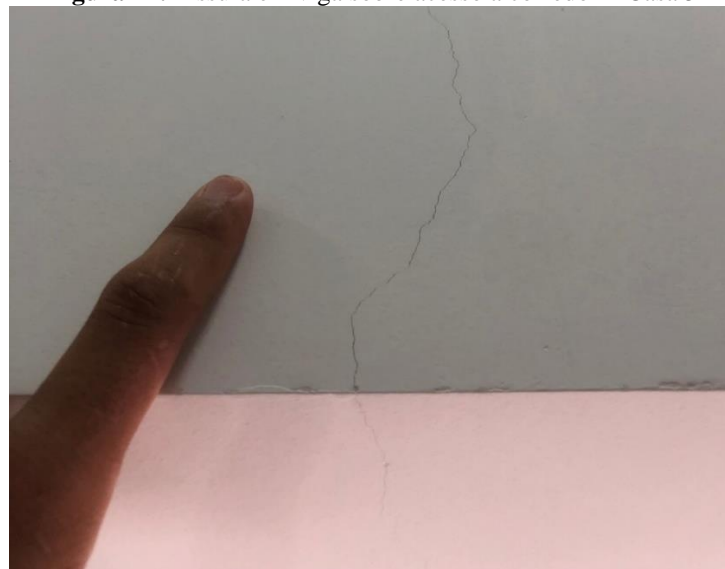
Fissura em viga sobre acesso a corredor – Casa 5
